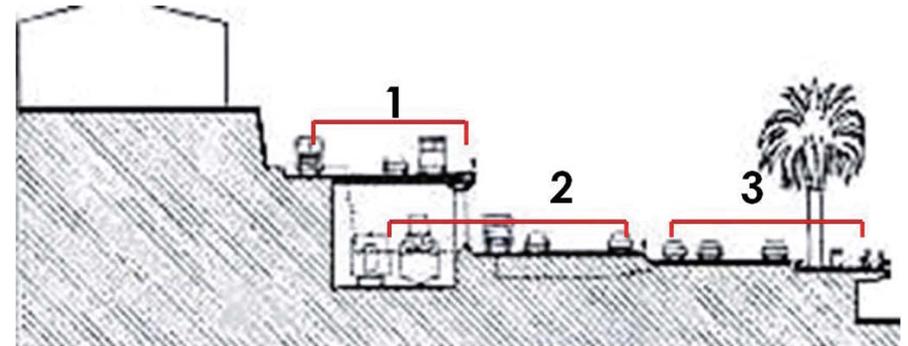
AVENIDA DEL MAR. Corte esquemático de la propuesta
